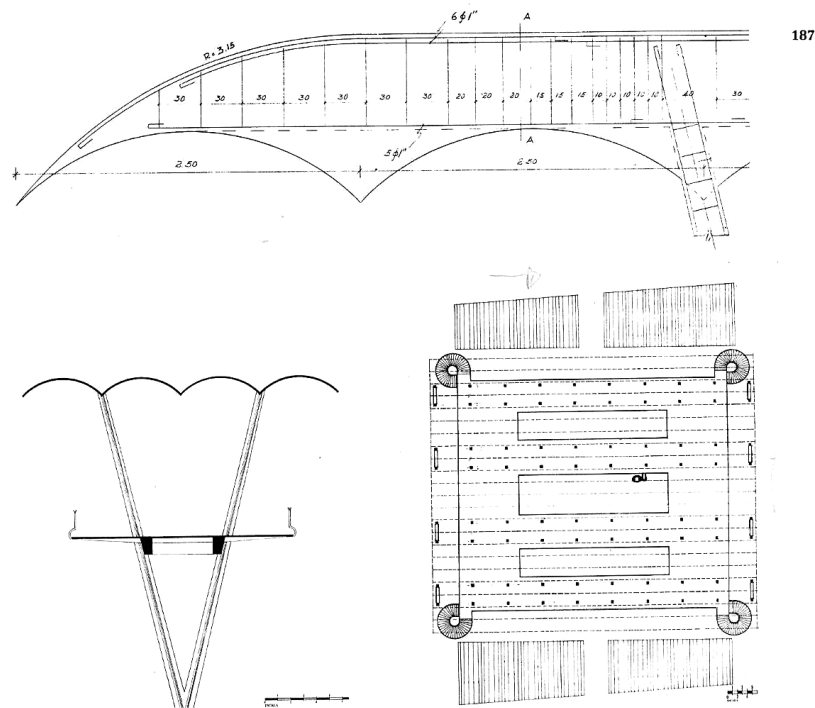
Baudetail der Schalenüberdachungen mit V-Stützen und Grundriss des Obergeschosses der Markthalle in Girardot.
